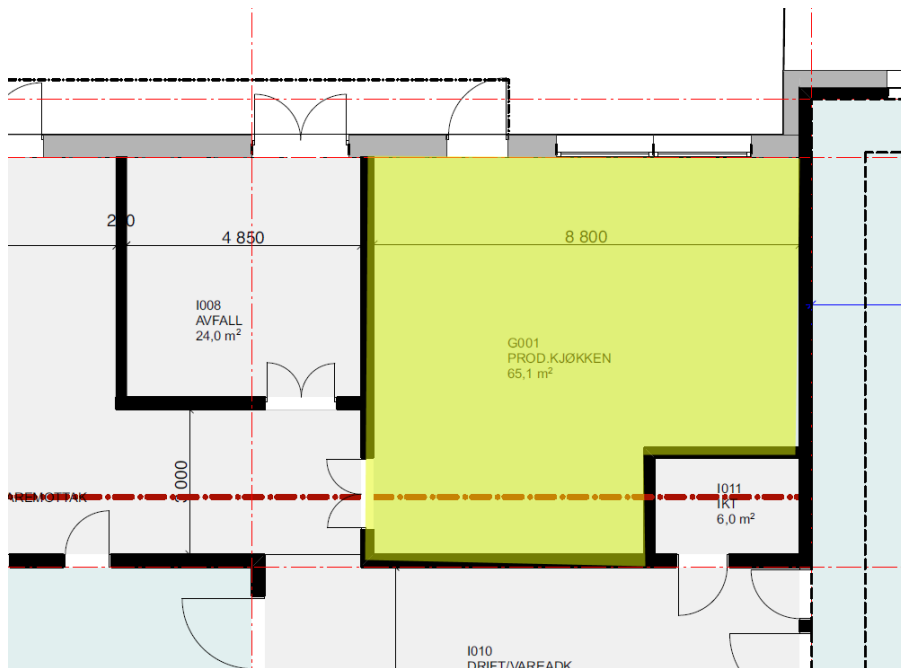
Utsnitt fra plantegning som viser plassering av avfallsrom i plan U.
